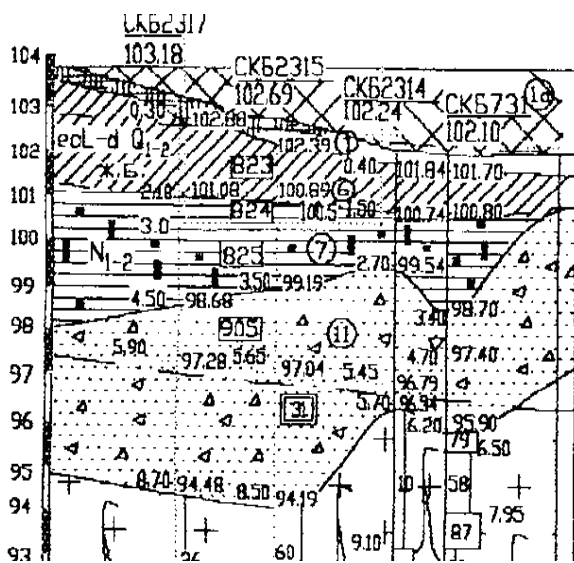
Инженерно-геологический разрез площадки строительства сооружения вентиляционной трубы
